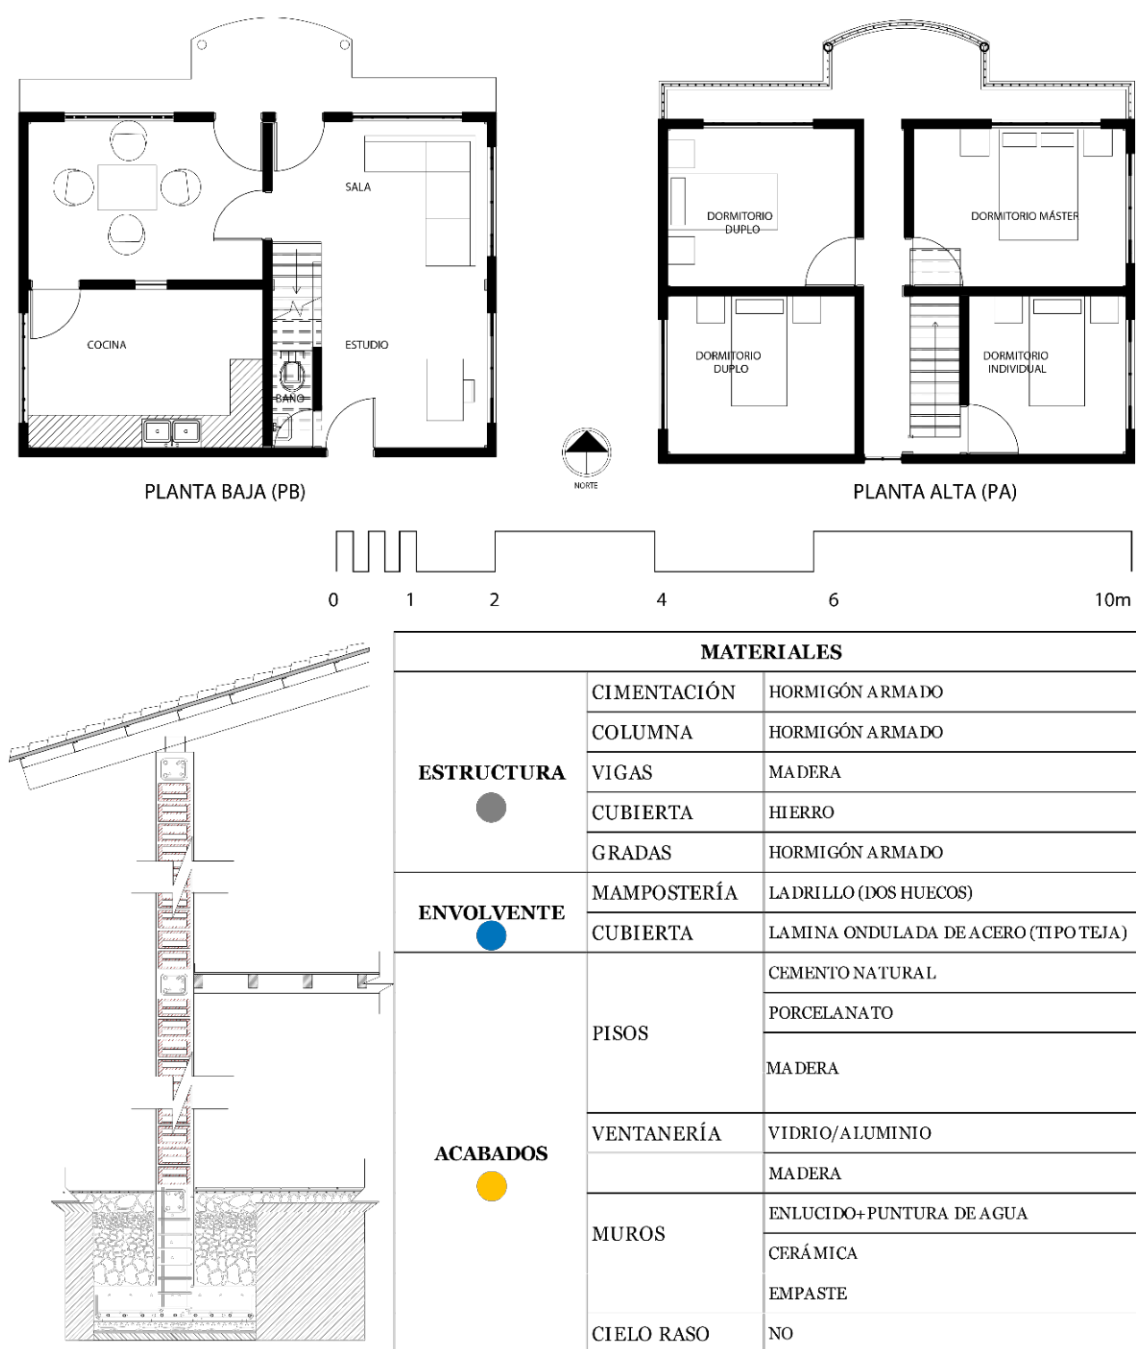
a) Planos de planta baja. b) Planos de planta alta. c) Sección constructiva. Fuente: Elaboración propia.
